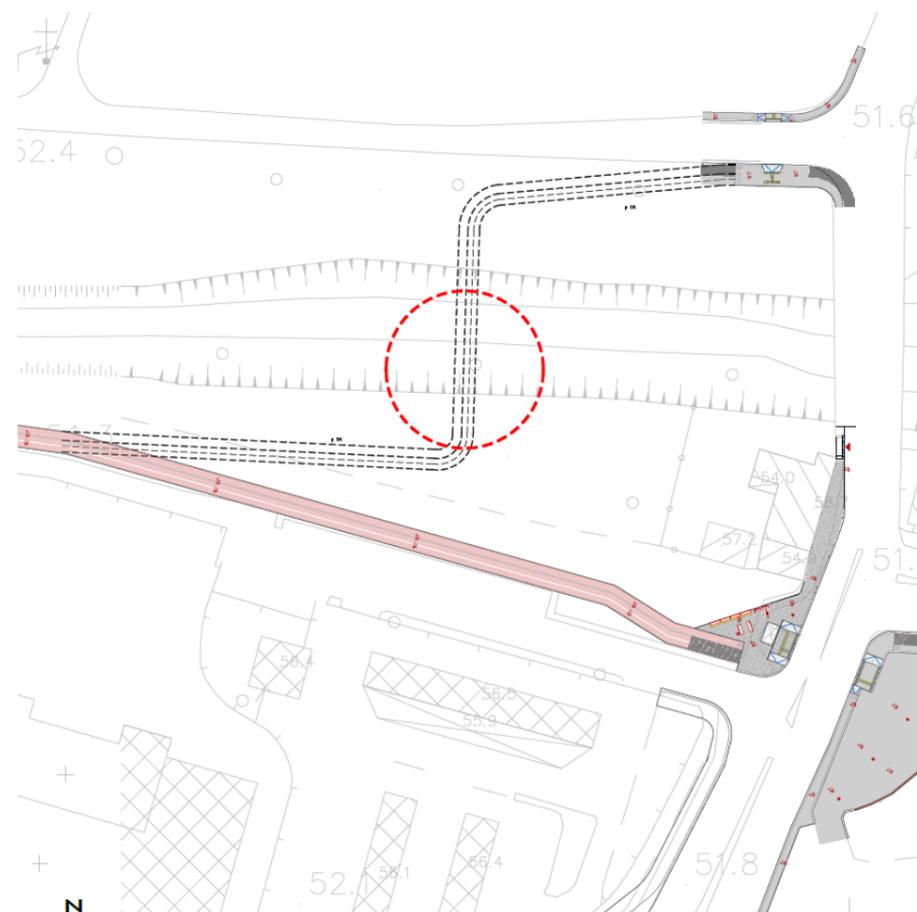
planimetria del posizionamento passerella sul Savena³⁹
